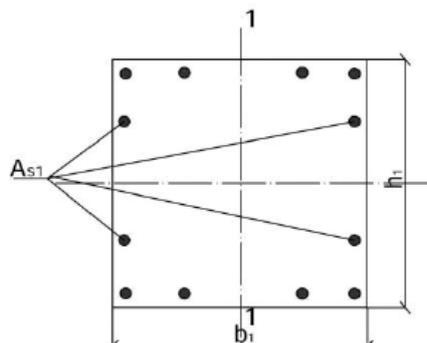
Схема центрально сжатого железобетонного элемента, усиленного железобетонной обоймой 1 – усиливаемый железобетонный элемент; 2 – железобетонная обойма; 3 – поверхность сцепления нового бетона со старым (зачистка, насечка, адгезионная обмазка);
